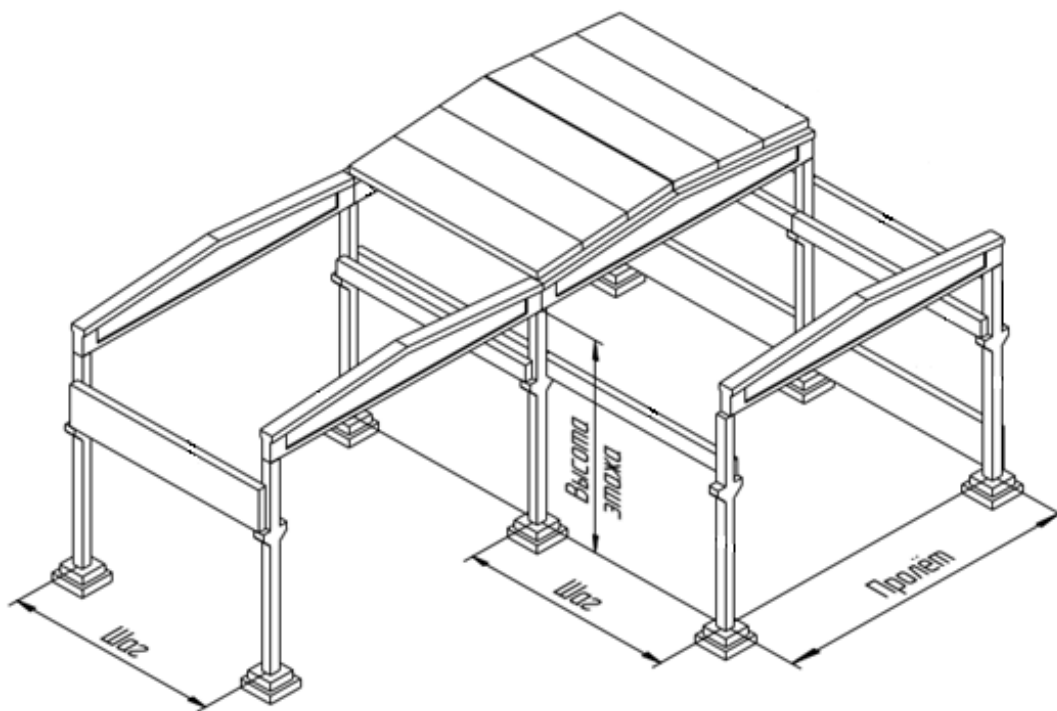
Пролет, шаг и высота этажа одноэтажного промышленного здания
